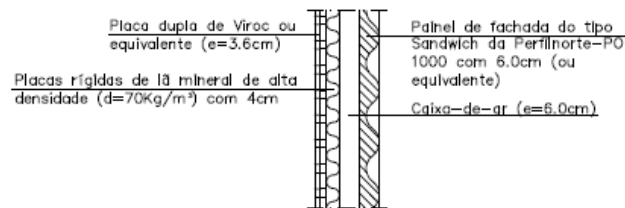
Corte das Paredes Pi2 e Pi3 (Fonte: Porto Vivo, SRU)
